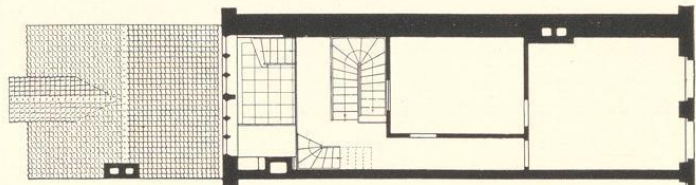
Grundriß des zweiten Obergeschosses des Hauses Prinzipalmarkt 22
